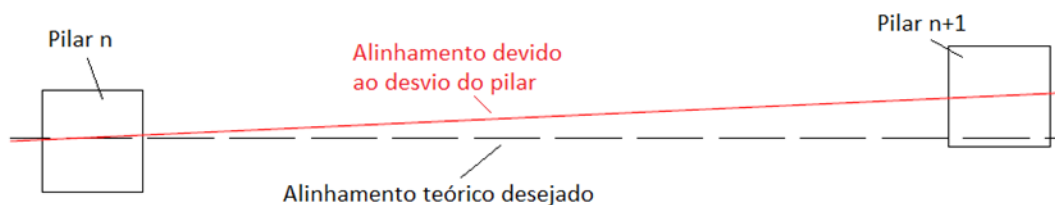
Alteração do alinhamento horizontal (planta) devido a desvio no alinhamento dos pilares
